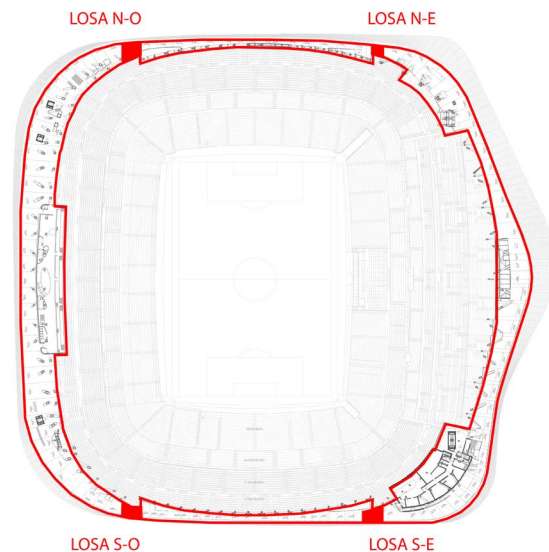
Planta general skywalk en Nivel 10 y ubicación de las losas de transición. Imagen generada para esta publicación.
